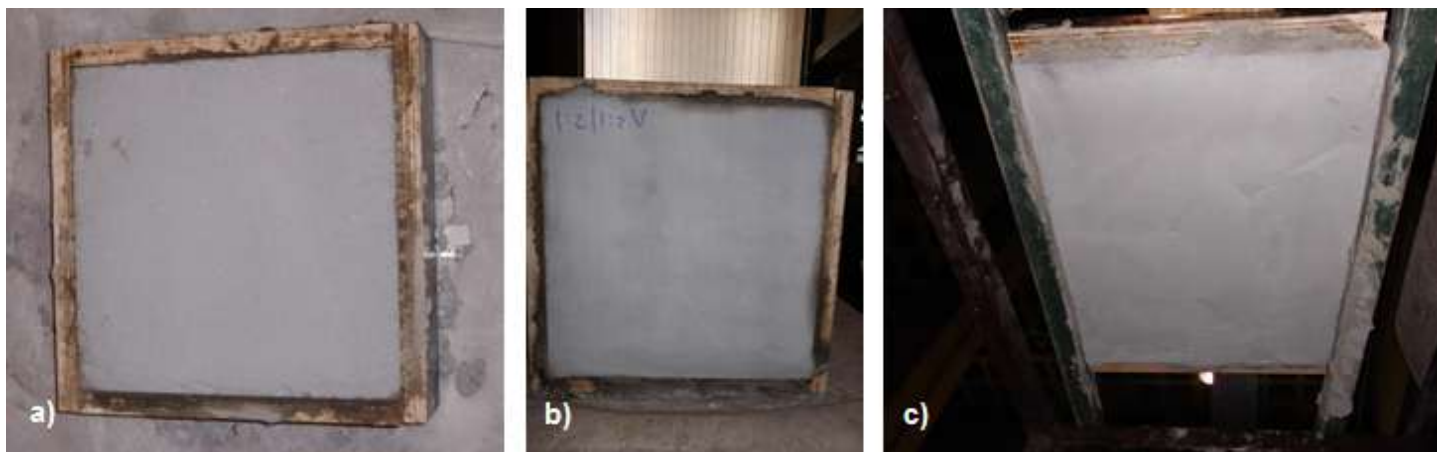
Argamassa PCM-SB-1 aplicada em lajetas representativas de pavimento (a), parede (b) e tecto (c).
